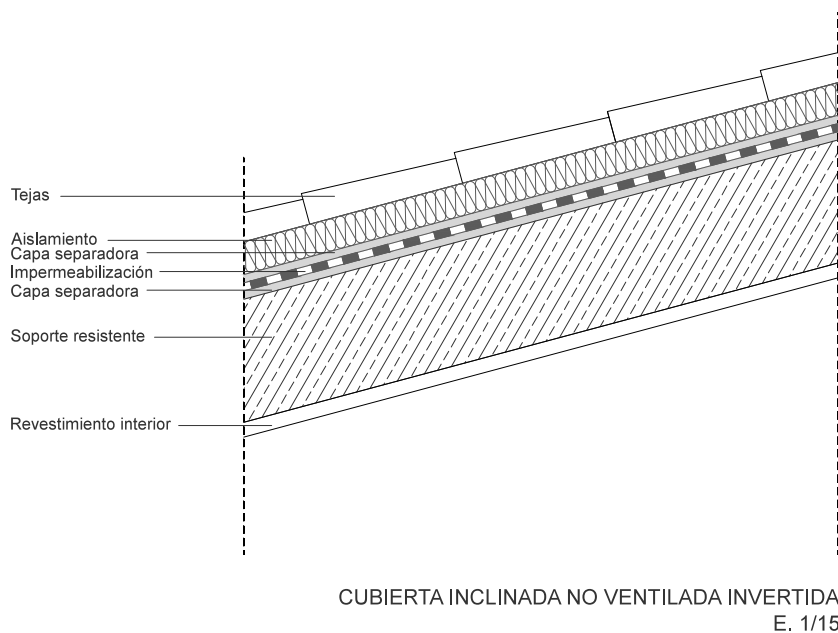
Detalle cubierta inclinada no ventilada invertida
